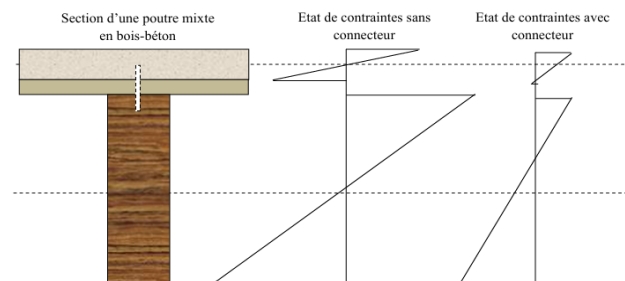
3: Etat de contraintes sans connecteur et avec connecteur dans un plancher mixte en bois-béton.
